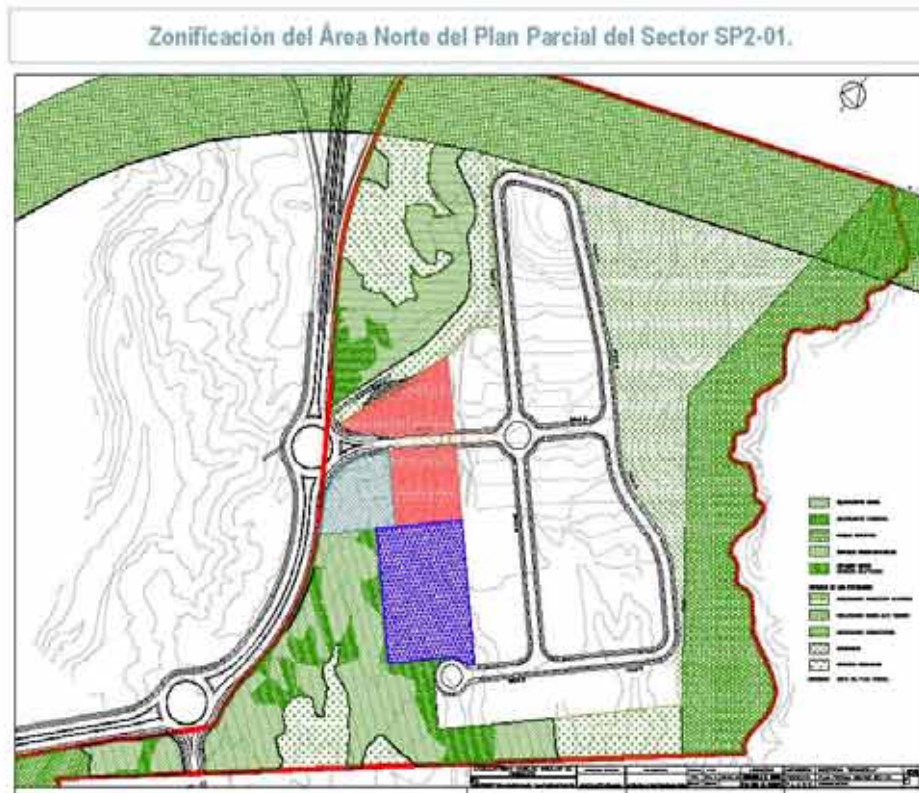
Plano de Zonificación del Suelo del Plan Parcial del Sector SP2-01. Área Norte
